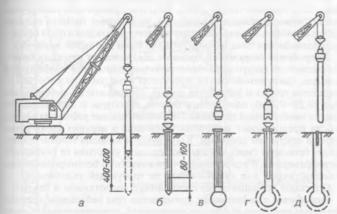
Технологическая схема устройства вибротрамбованных свай: а — образование скважины; 6 — укладка первой порции бетонной смеси; в — уплотнение бетонной смеси трамбующей штангой, жестко соединенной с вибропогружа-
